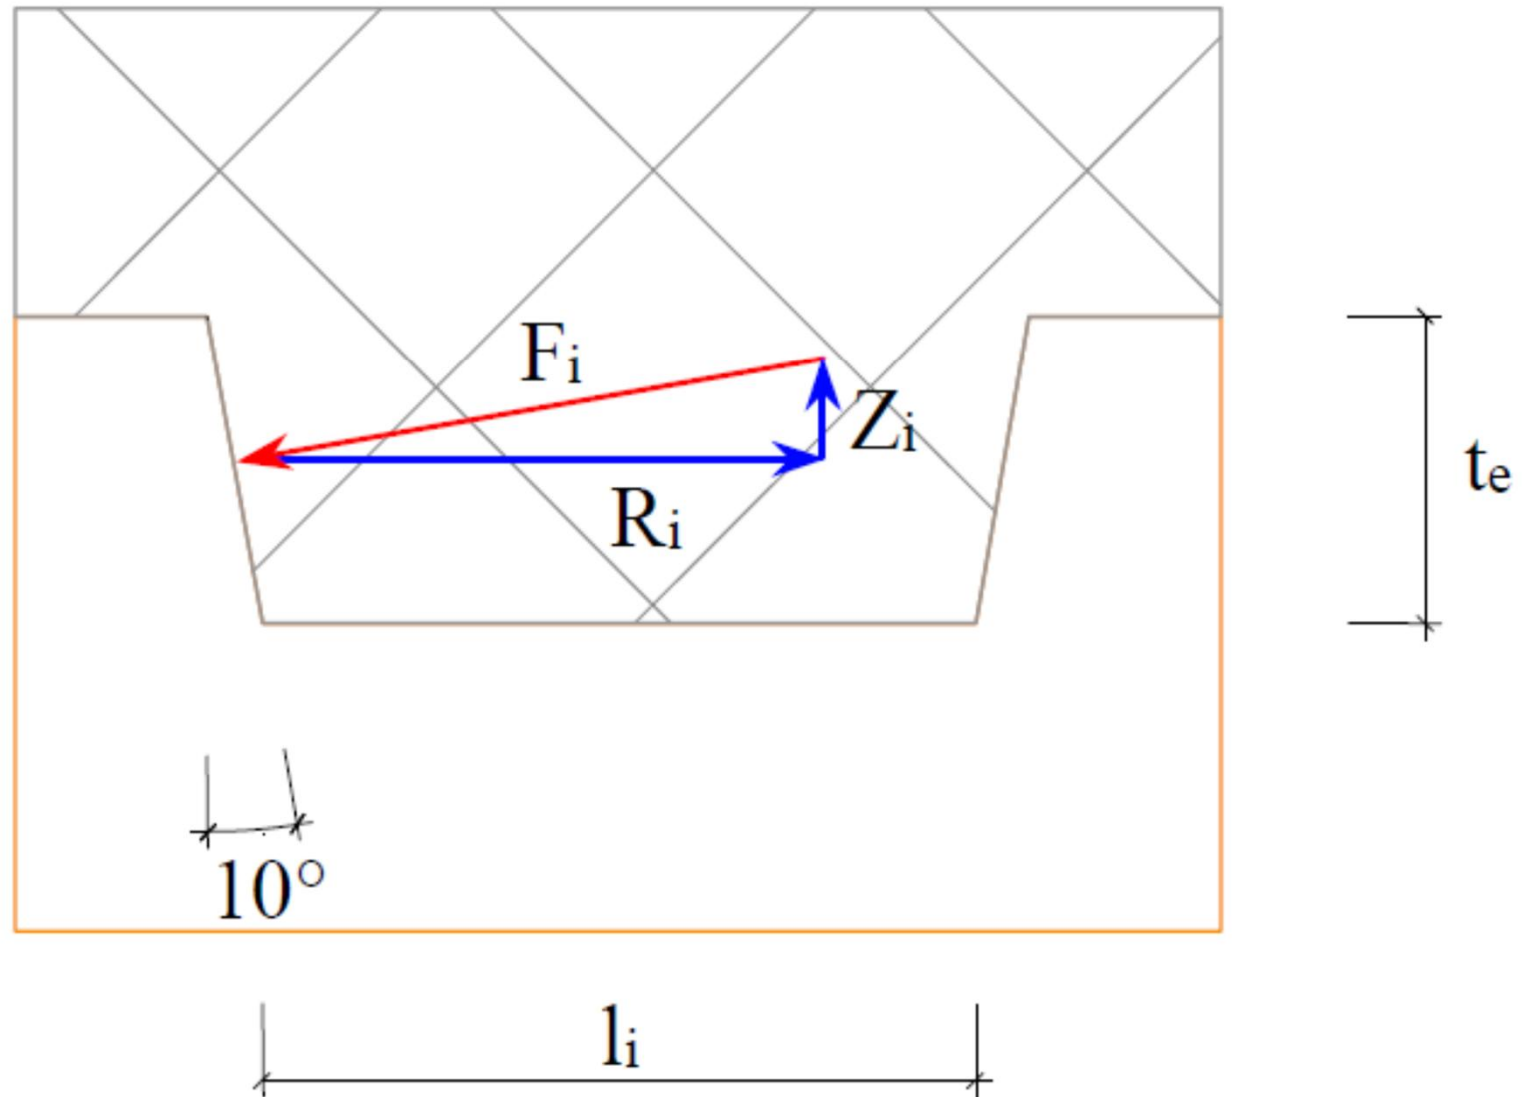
Détail d'un goujon dans une rainure de dalle mixte bois-béton.
